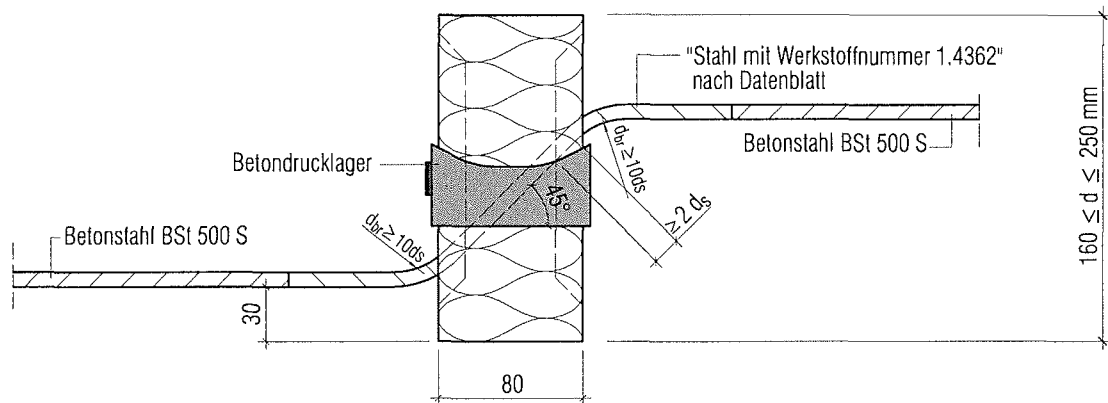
Schöck Isokorb Typ Q mit Betondrucklager
